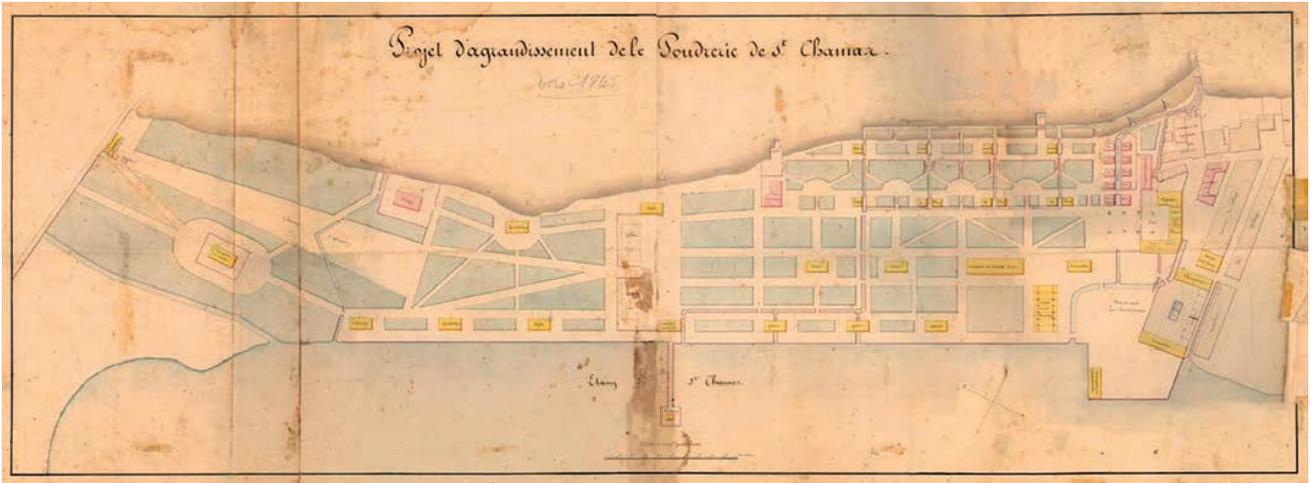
Plan d'agrandissement de la Poudrière 1845 (AD BDR : plan 5.1).
